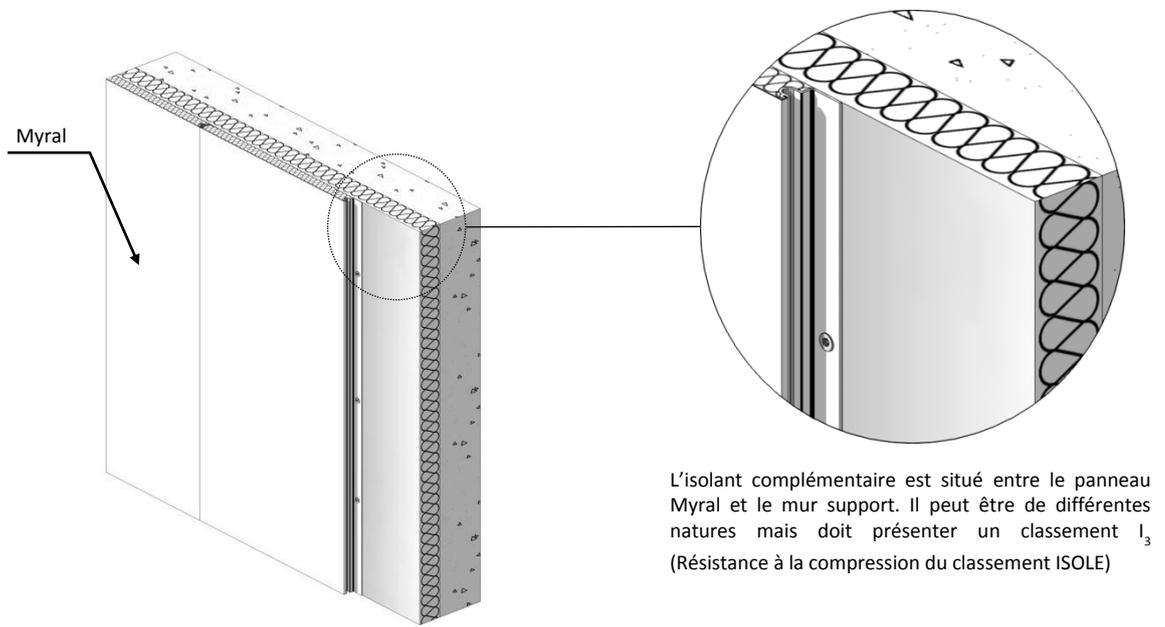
2- Pose en vêtire (lames verticales) sur mur béton ou maçonné
